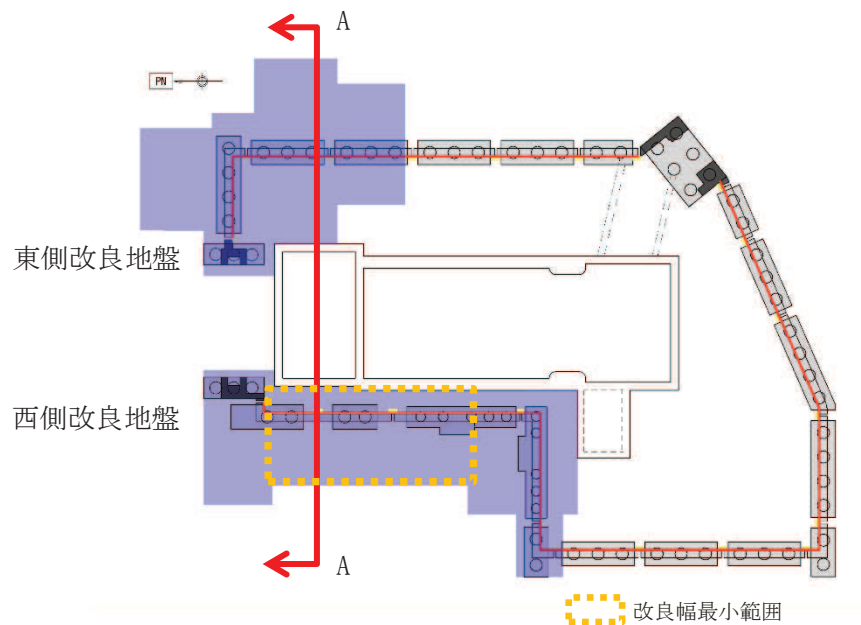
第2号機放水立坑改良地盤評価対象断面 平面図
